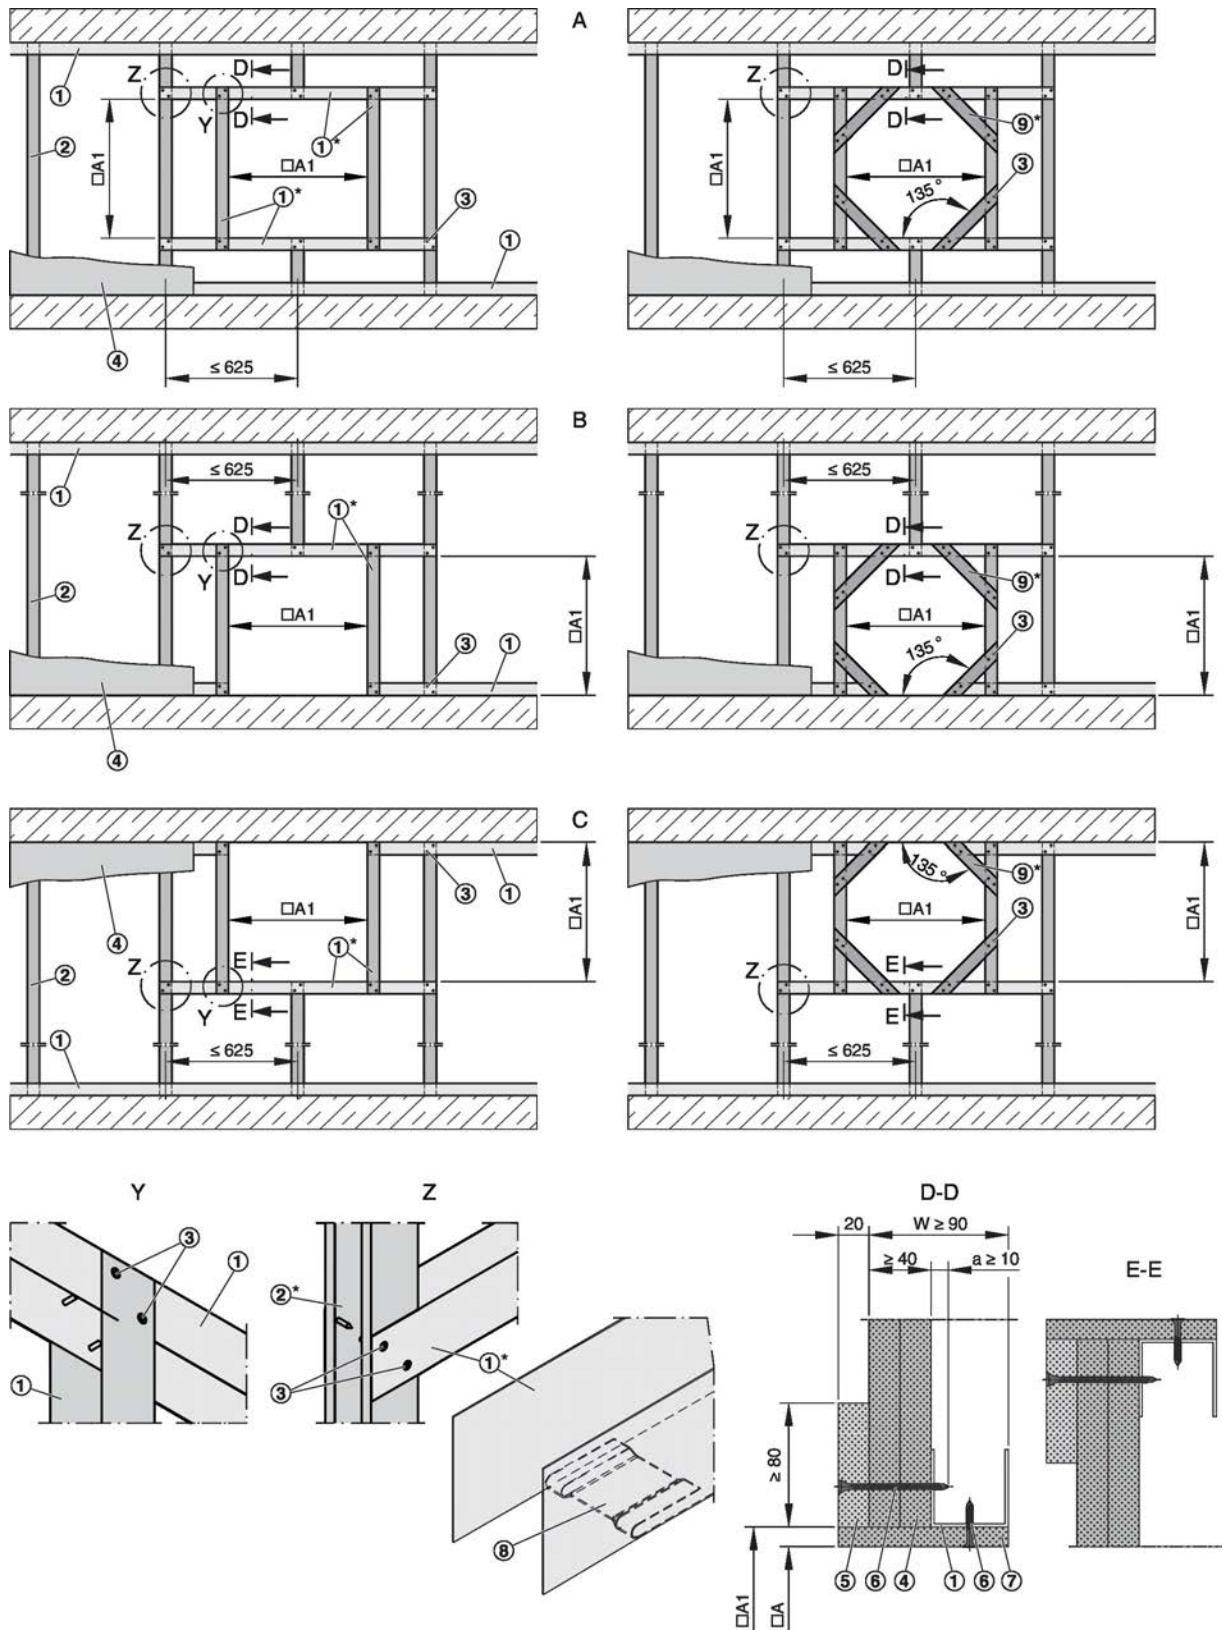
Patinillos con estructura de pared metálica y aislamiento a un lado
